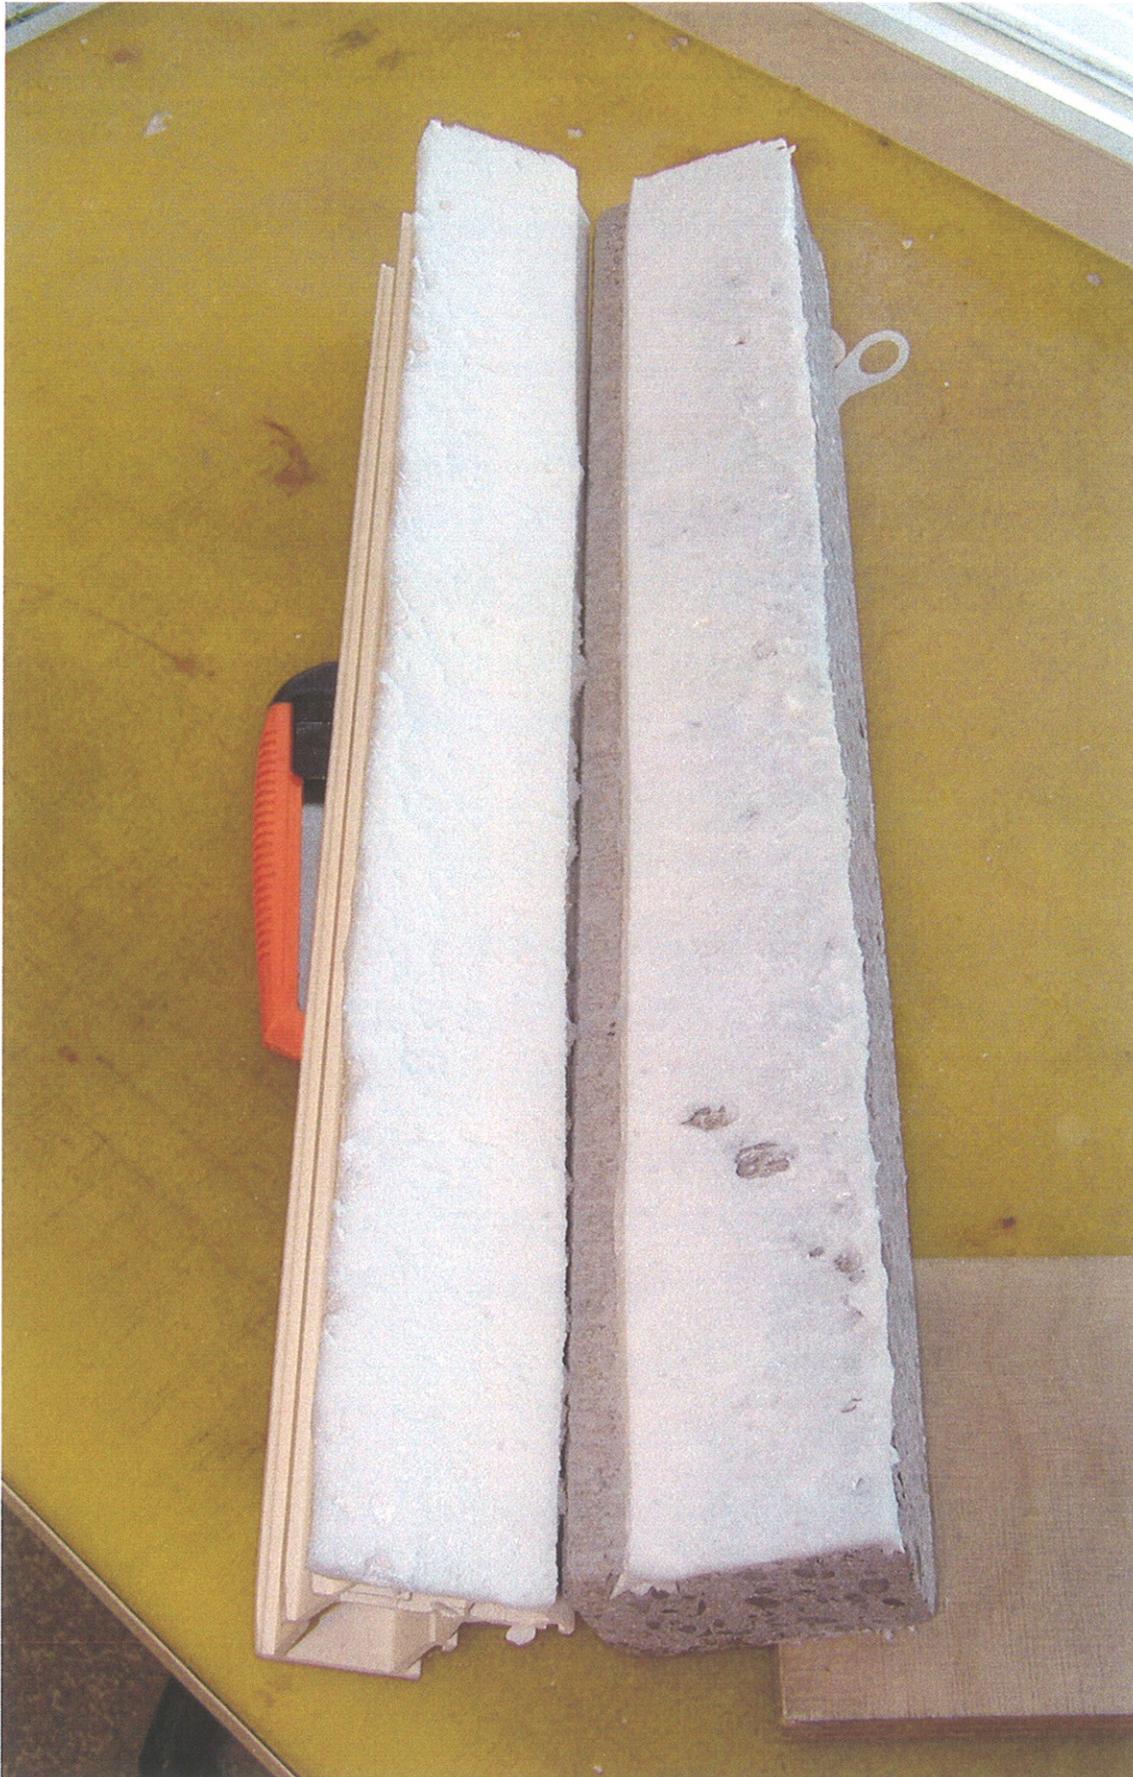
Betonflanke und PVC-Flanke nach dem Auseinanderklappen des mittig durchgeschnittenen Fugenschauums
